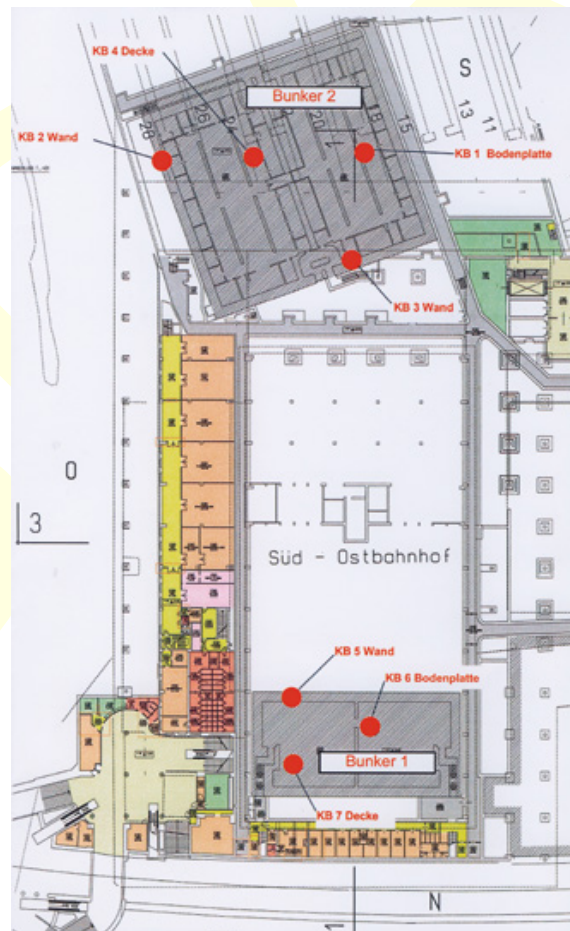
Im Situationsplan des Ausschreibungsplanes zu dem neu geplanten Zentralbahnhof sind auch die beiden Luftschutzbunker eingezeichnet. Ausgewiesen sind die Stellen, an denen mittels Probebohrungen die meterdicken Betondecken, -wände und -bodenplatten eruiert wurden.
